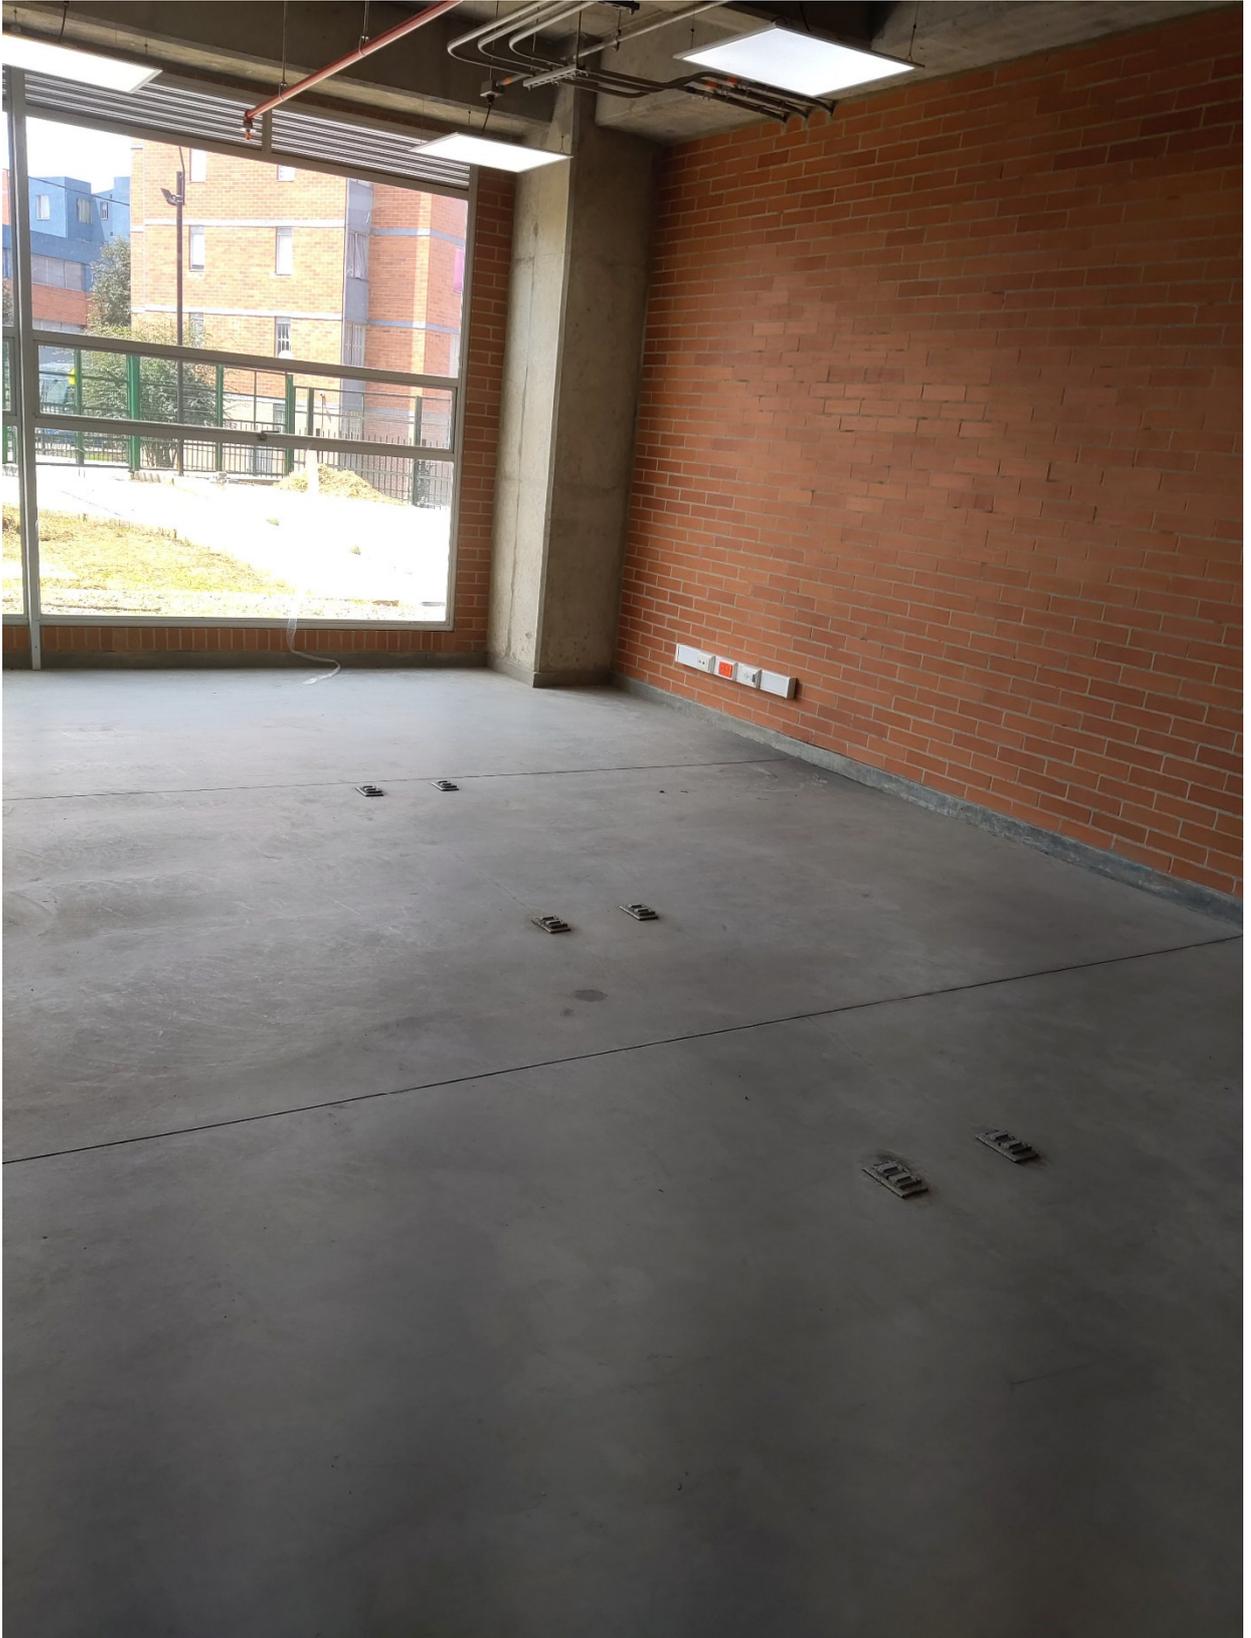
Laboratorios del primer piso, tener encuentra textura de piso, muro y techo
